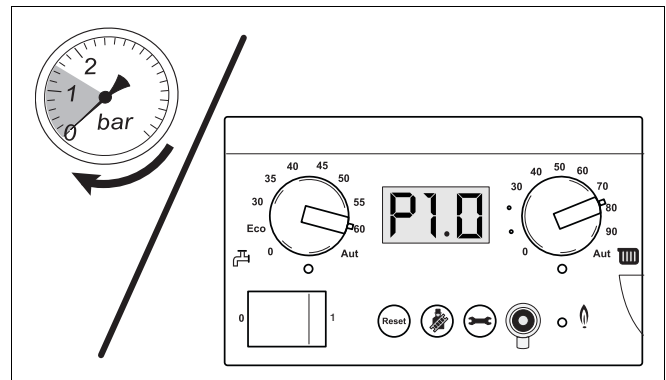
Відкрити водопровідний кран та наповнити опалювальну установку
